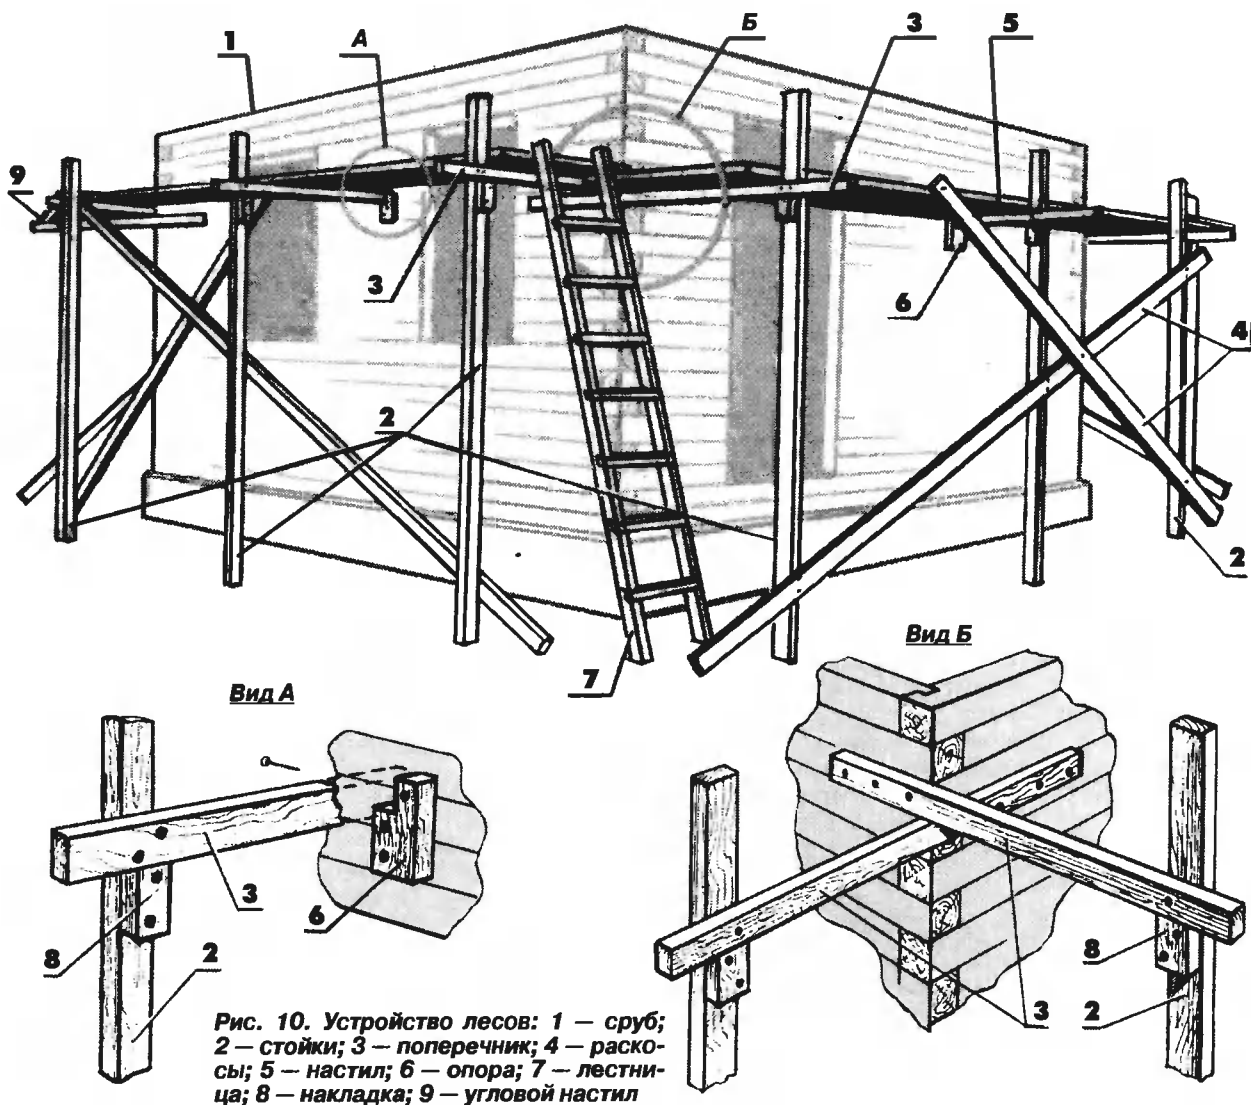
Устройство лесов: 1 – сруб; 2 – стойки; 3 – поперечник; 4 – раскосы; 5 – настил; 6 – опора; 7 – лестница; 8 – накладка; 9 – угловой настил
